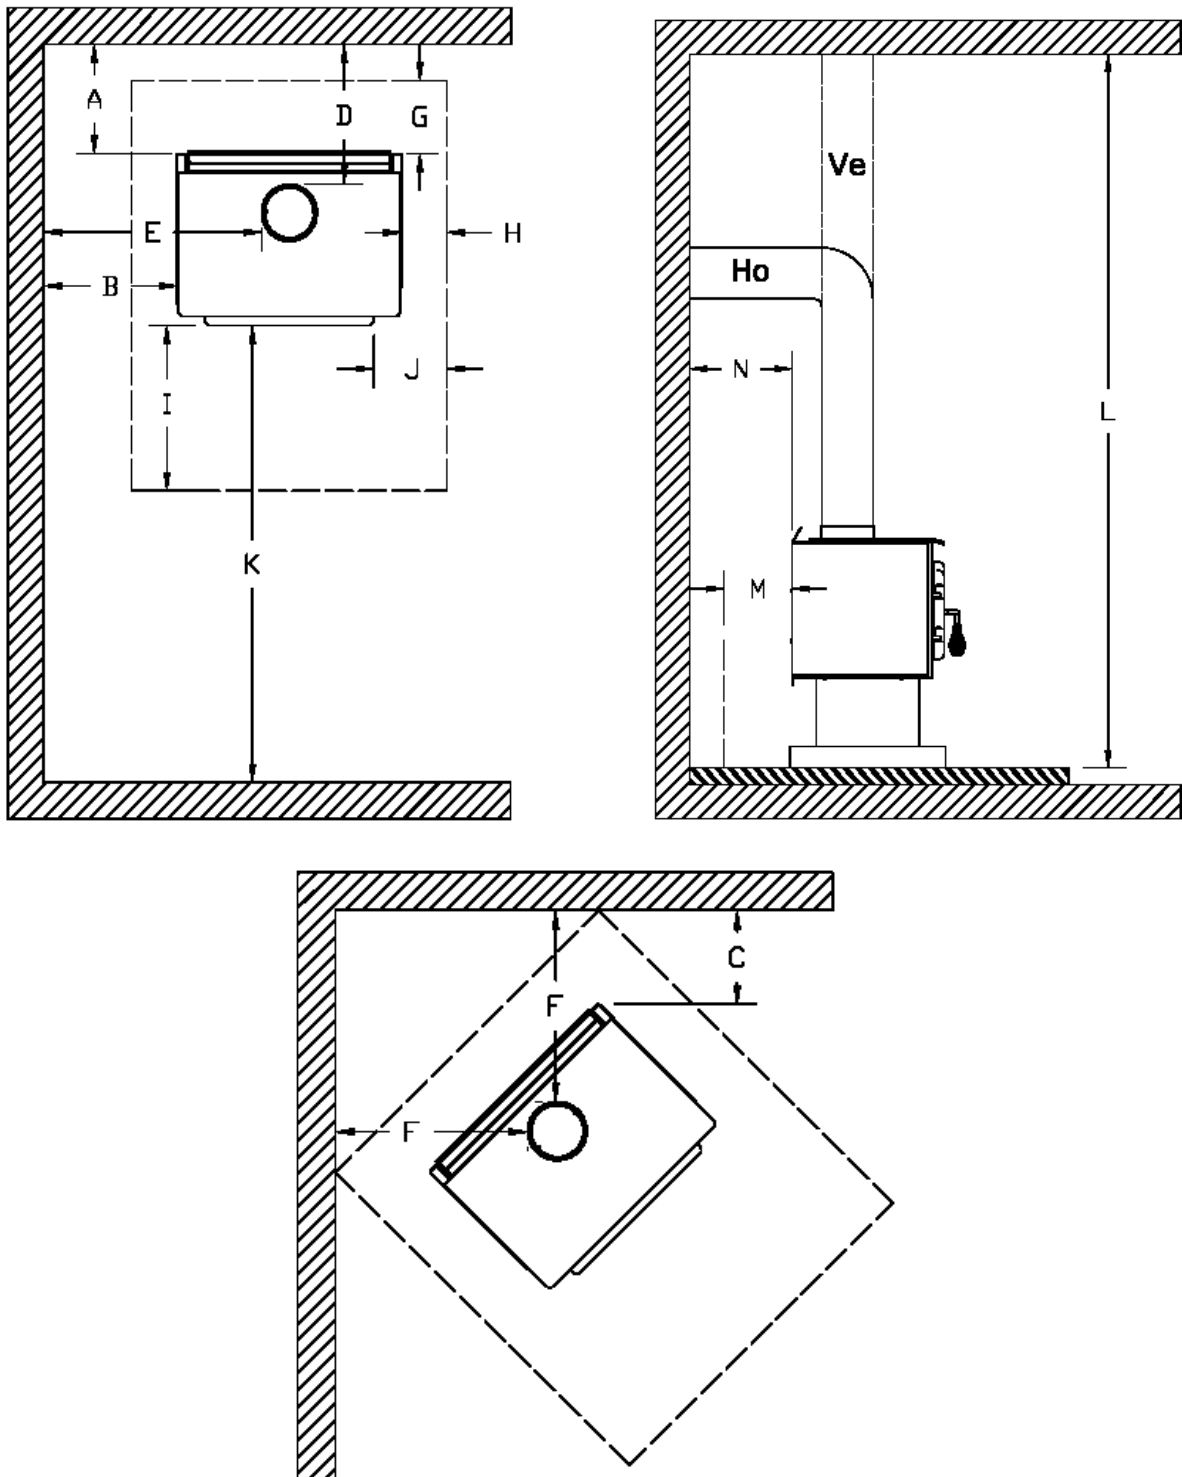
Dégagements aux matériaux combustibles et protection du plancher
